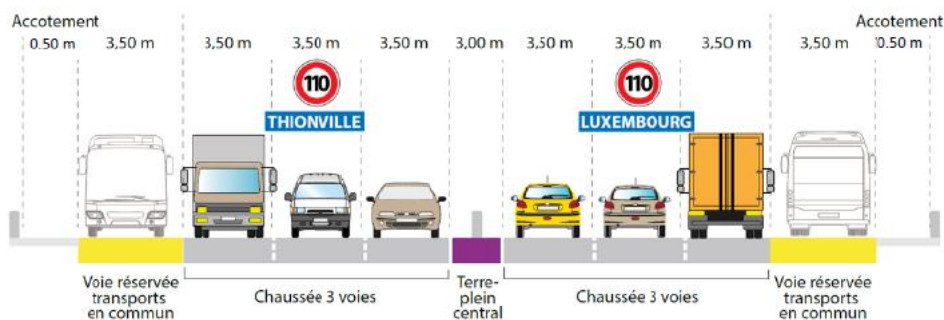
profil en travers de l'A31bis sur le secteur nord partie nord (source : dossier)
